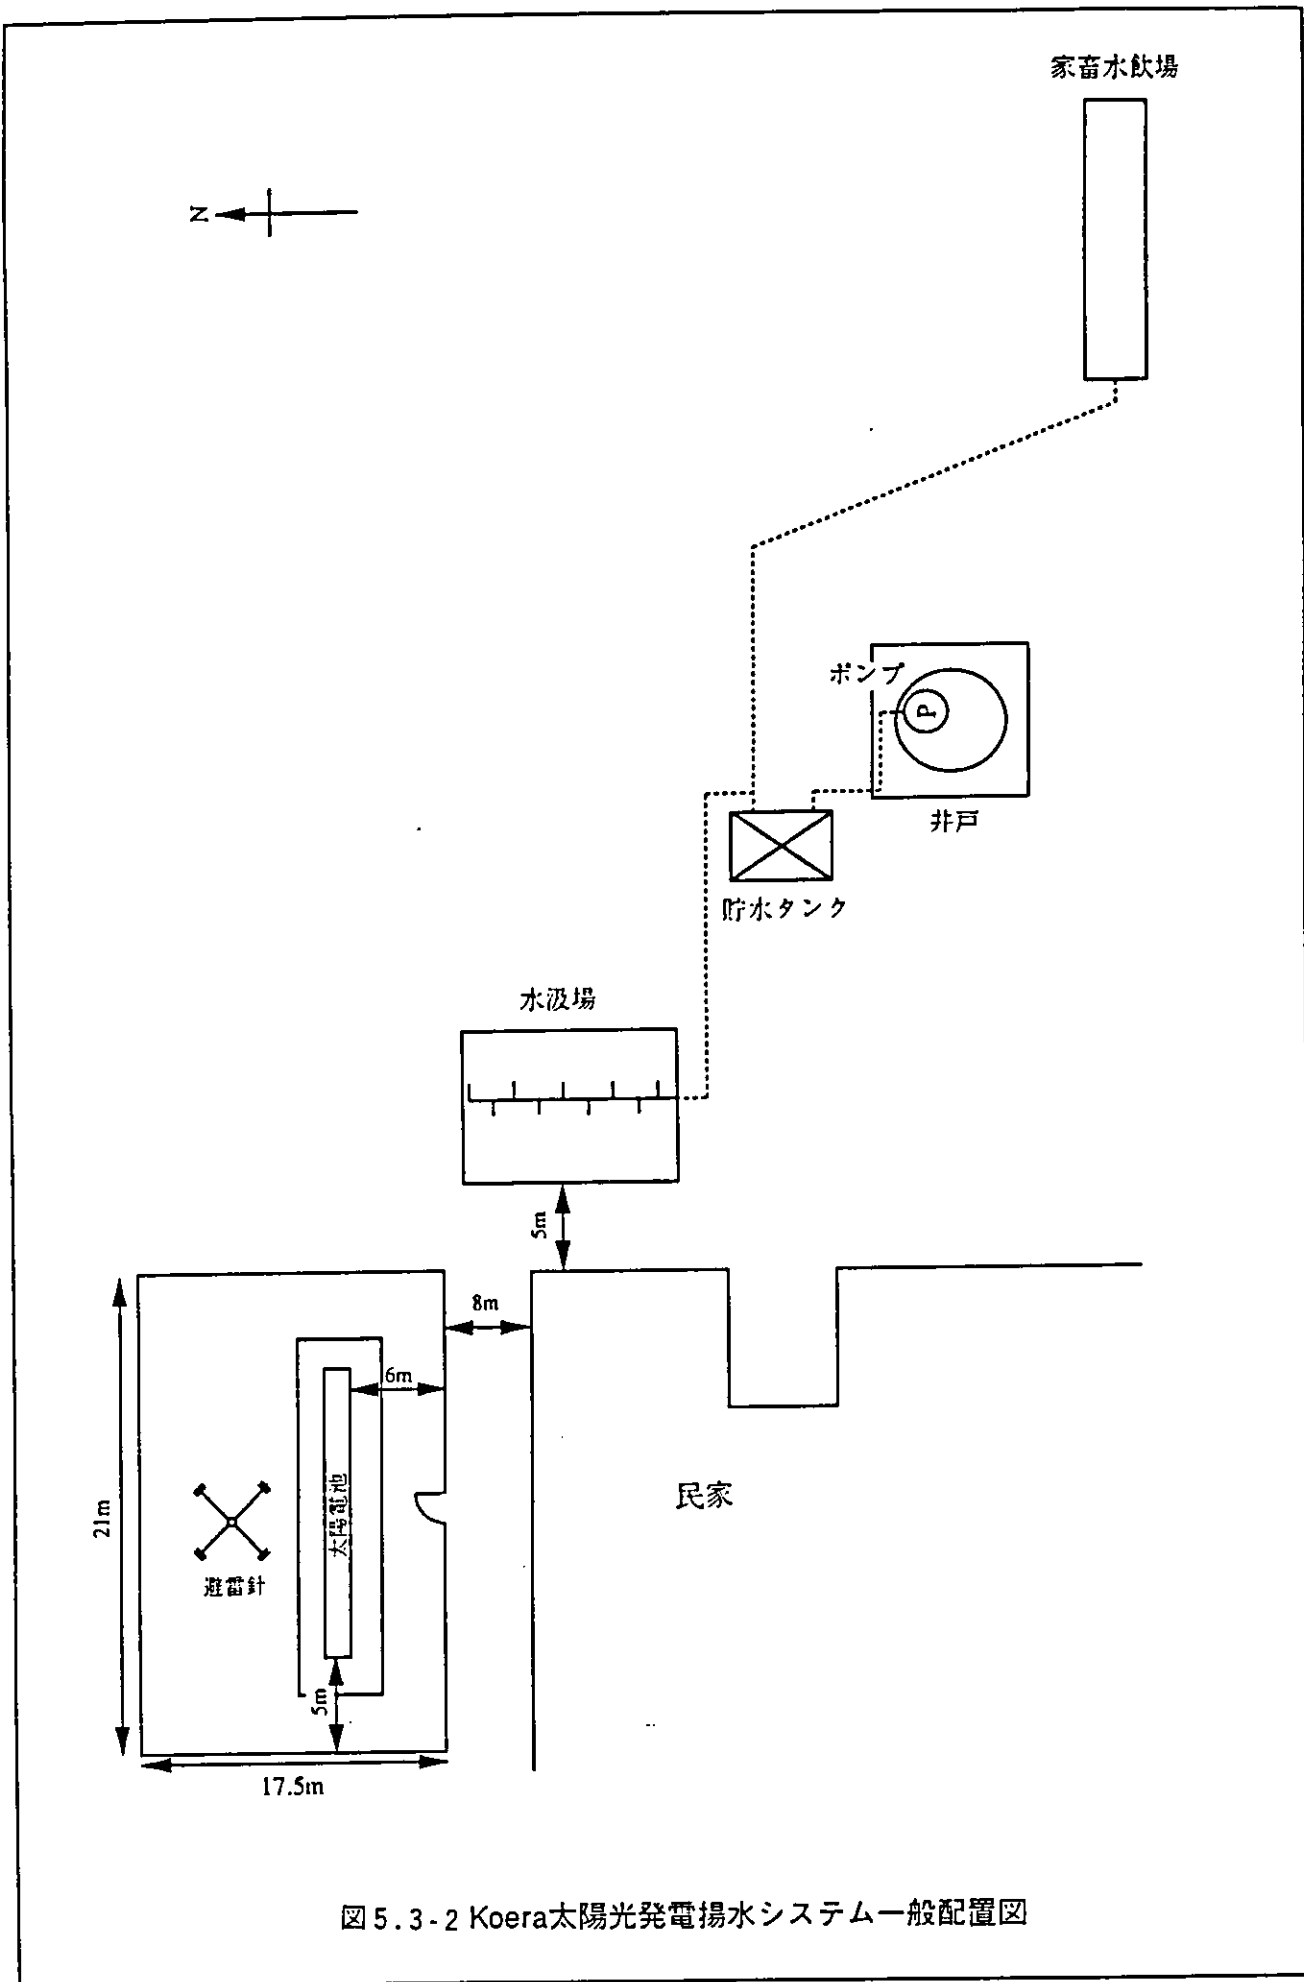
Koera太陽光発電揚水システム一般配置図
